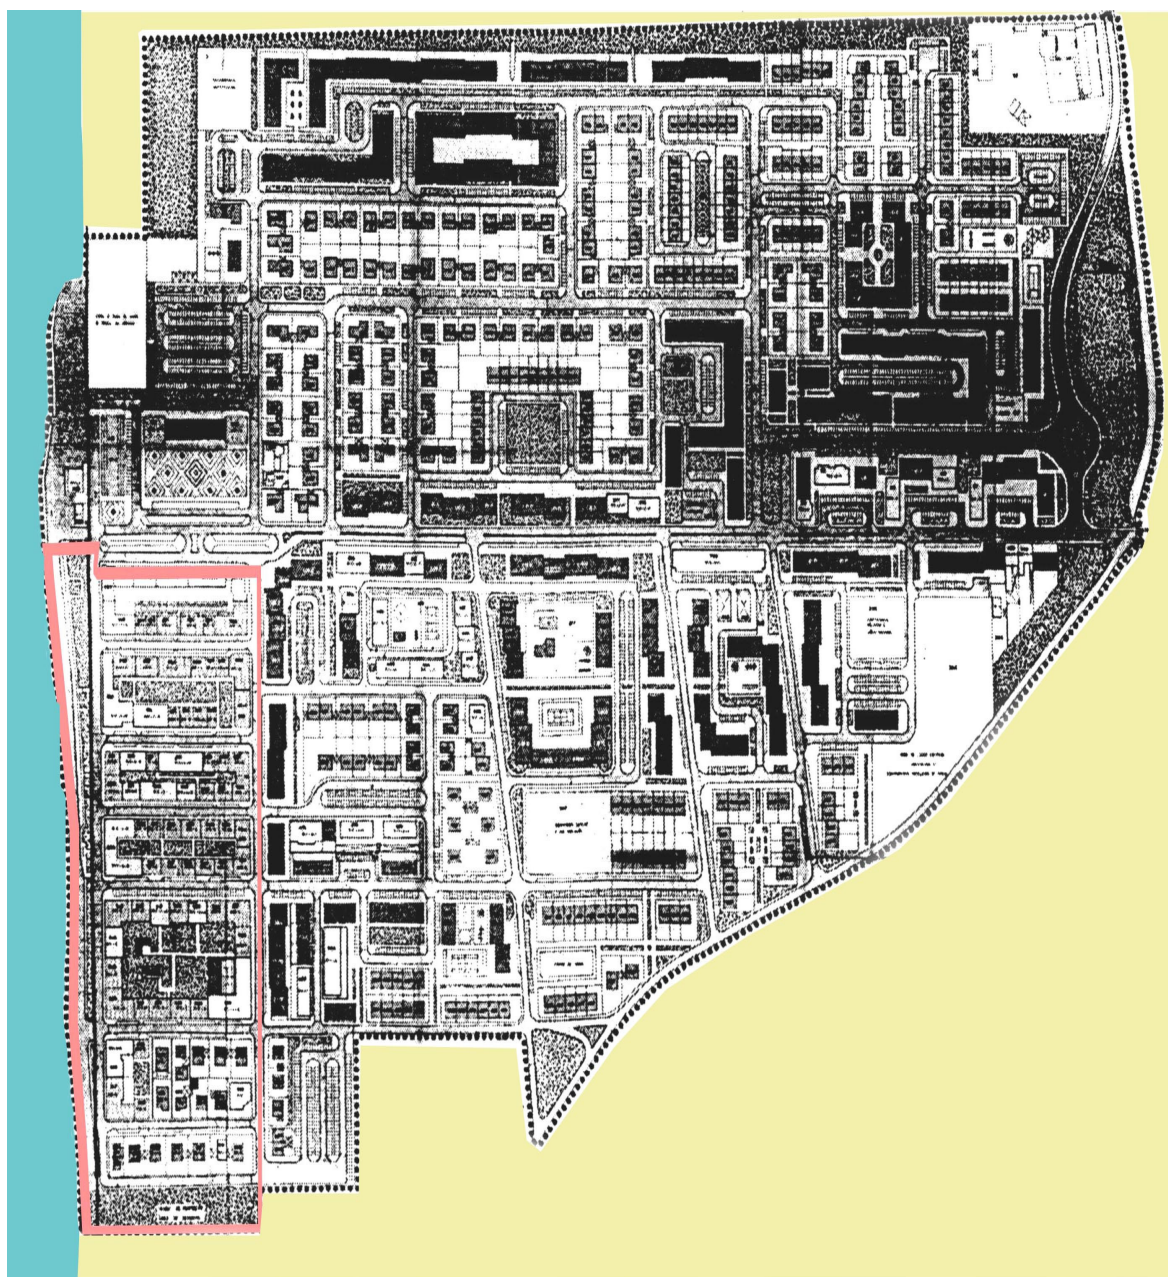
Planta de síntese do Plano de Pormenor da Vagueira (Adaptado de: D.R. n.º 165/89 de 20 de Julho).
